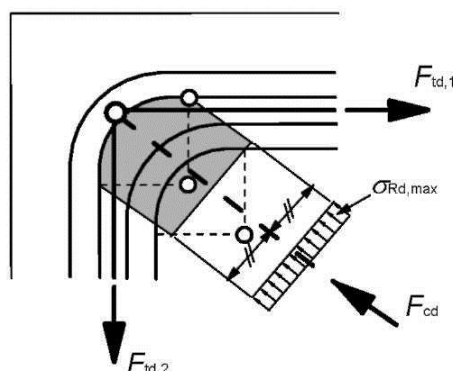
Сжато-растянутый узел с арматурой в двух направлениях
